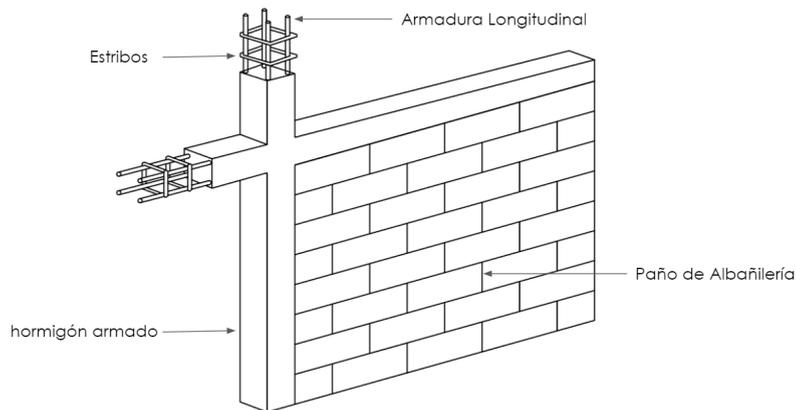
Albañilería reforzada, Fuente elaboración propia.
